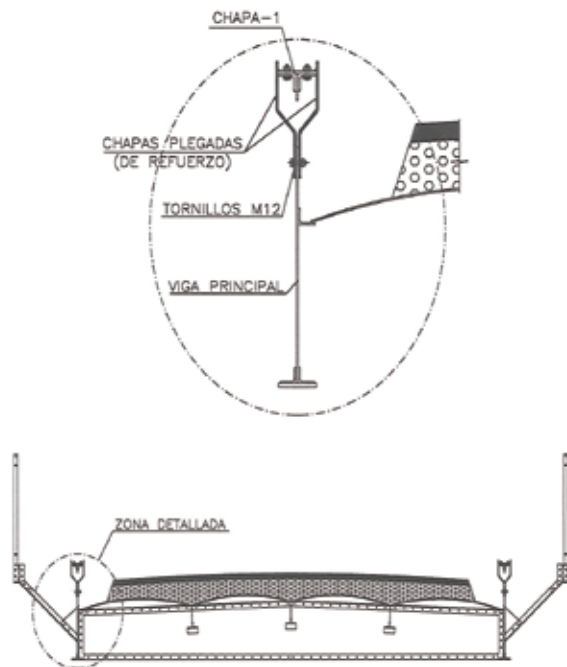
Fase 3: colocación de las chapas de refuerzo laterales
